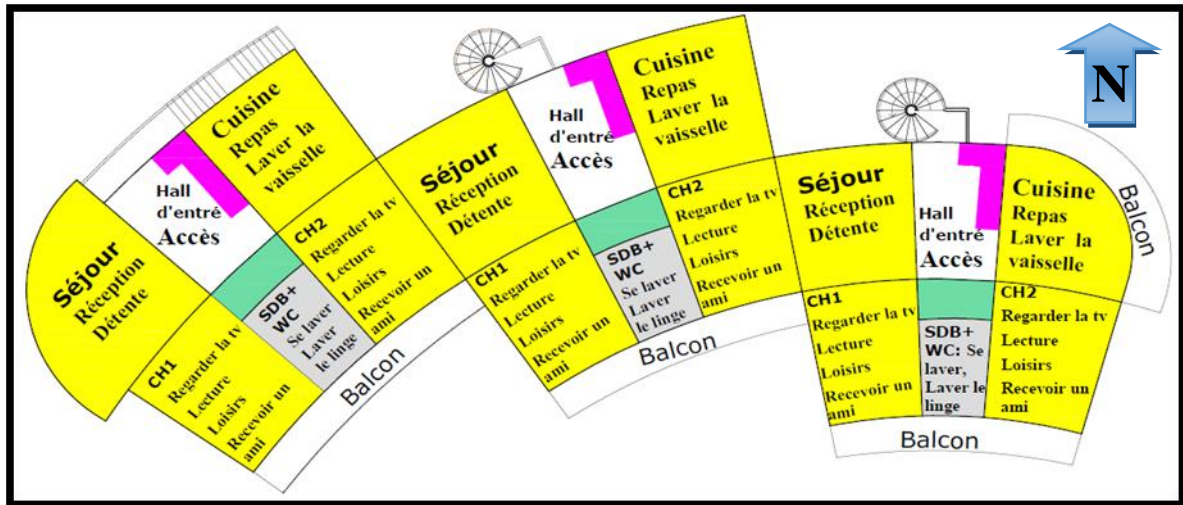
Plan de 1^{er} Etage. Source auteur.
